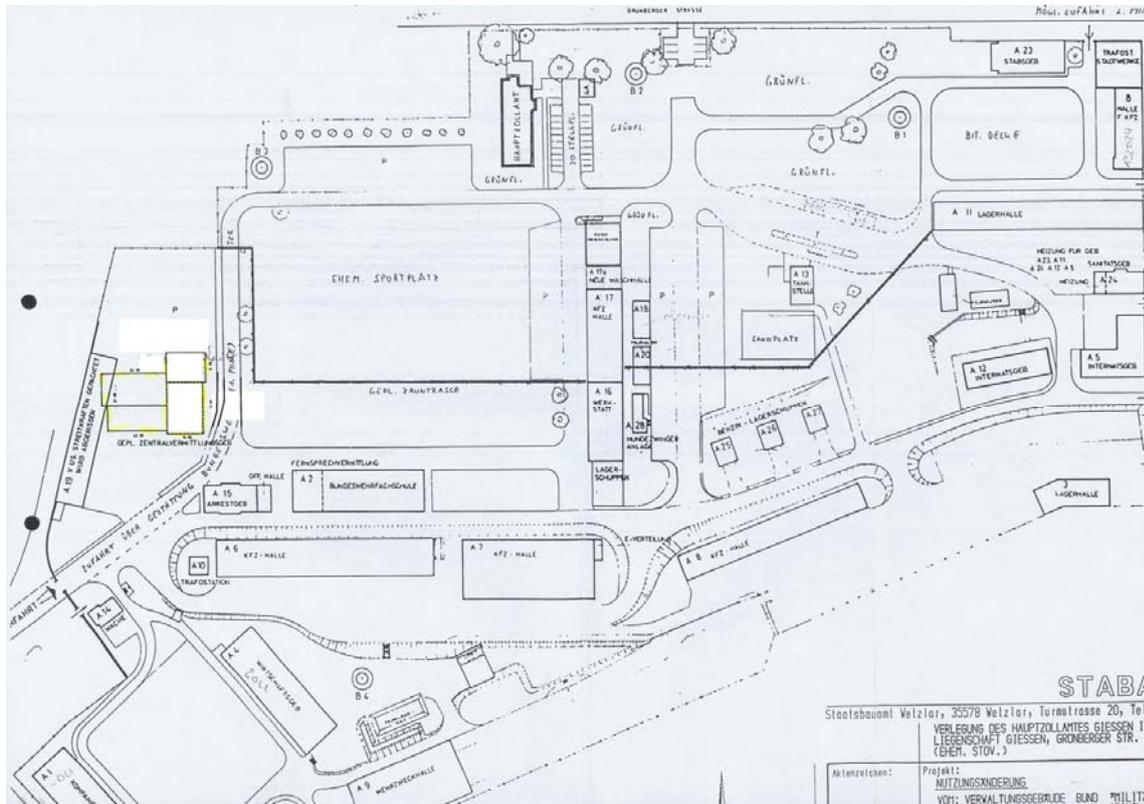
Bestandslageplan mit Gebäudenummern, Quelle: Hessisches Baumanagement
